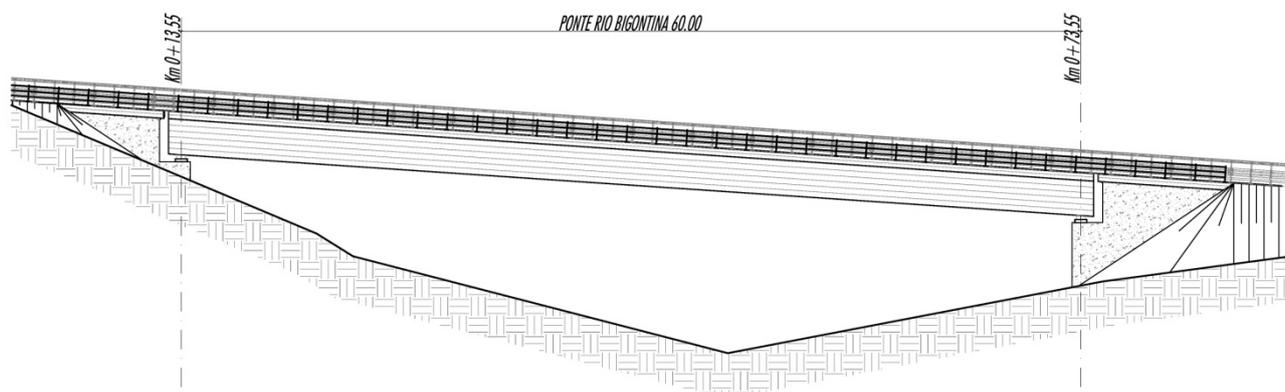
Prospetto del Ponte sul Rio Bigontina (ns. elaborazione da tavola T01VI02STRDI01_A_Sezione longitudinale, prospetto e schema appoggi del progetto definitivo).
